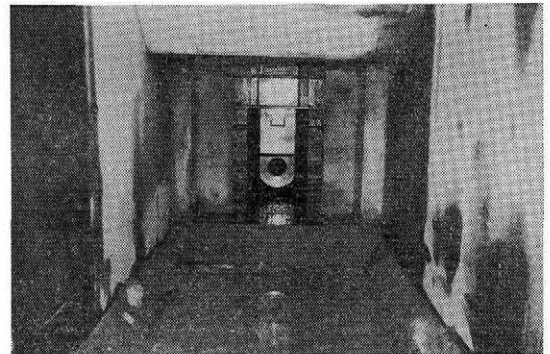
減勢室よりジェットフローゲート（φ185）を望む
